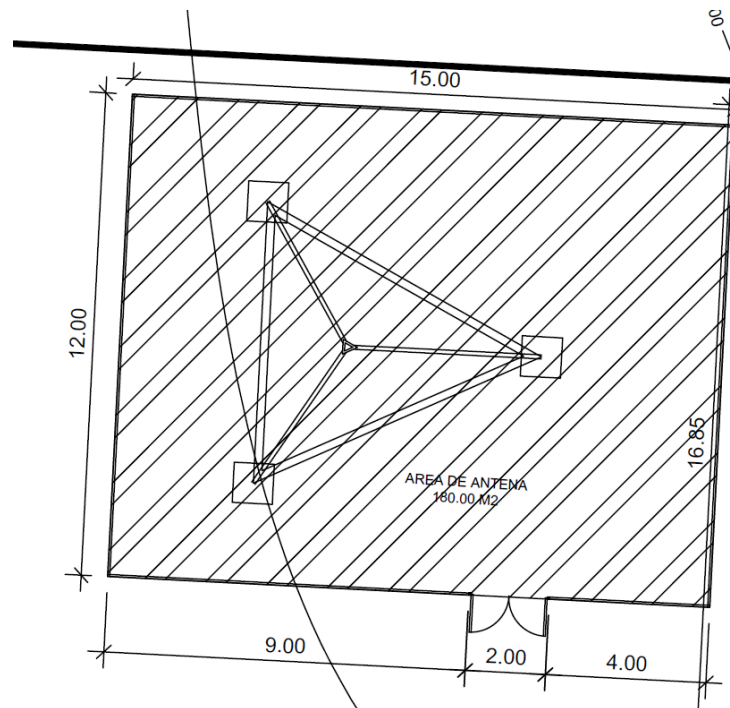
Planta general de la antena existente. Fuente: Planos del proyecto, 2024.
